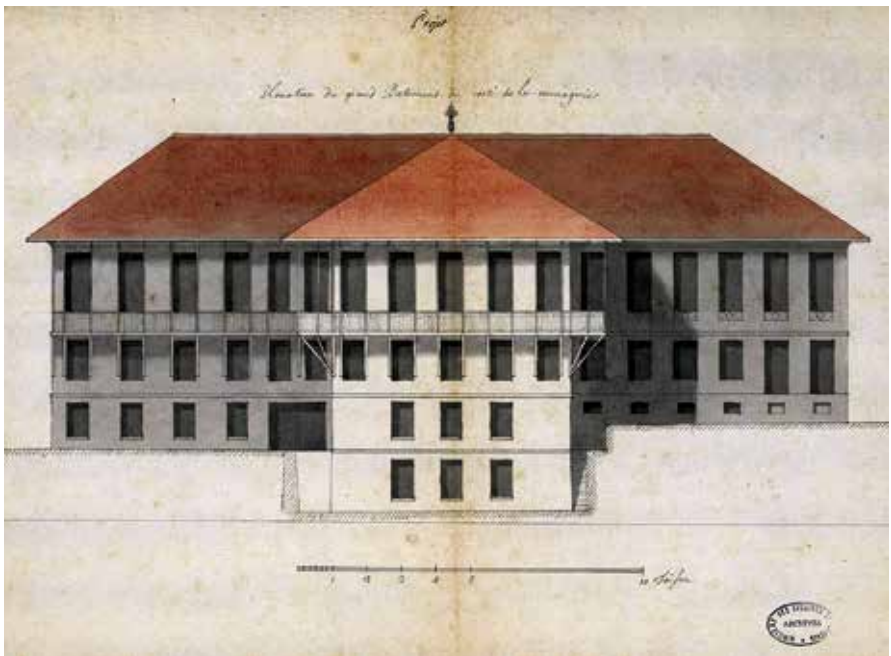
Vigné de Vigny, Projet pour l’ambassade de France à Constantinople, « Elevation du grand Batiment du costé de la menagerie » [1722]
